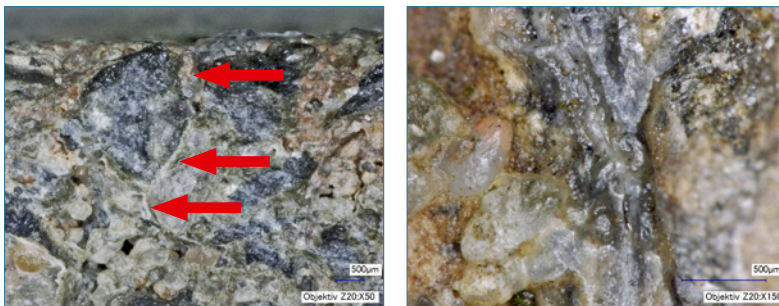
Detailbild eines zugesinterten Risses in der Oberfläche eines Betonpflastersteins
